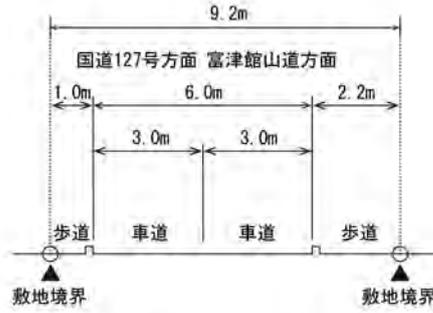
(1) 予測断面図 (A 県道 258 号富山丸山線)
